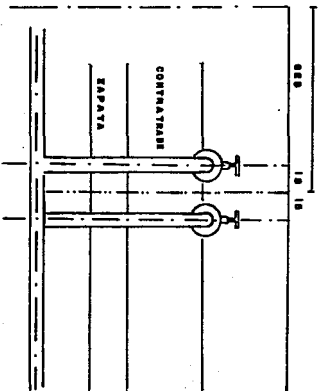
DETALLES DE INSTALACION HIDRAULICA.
